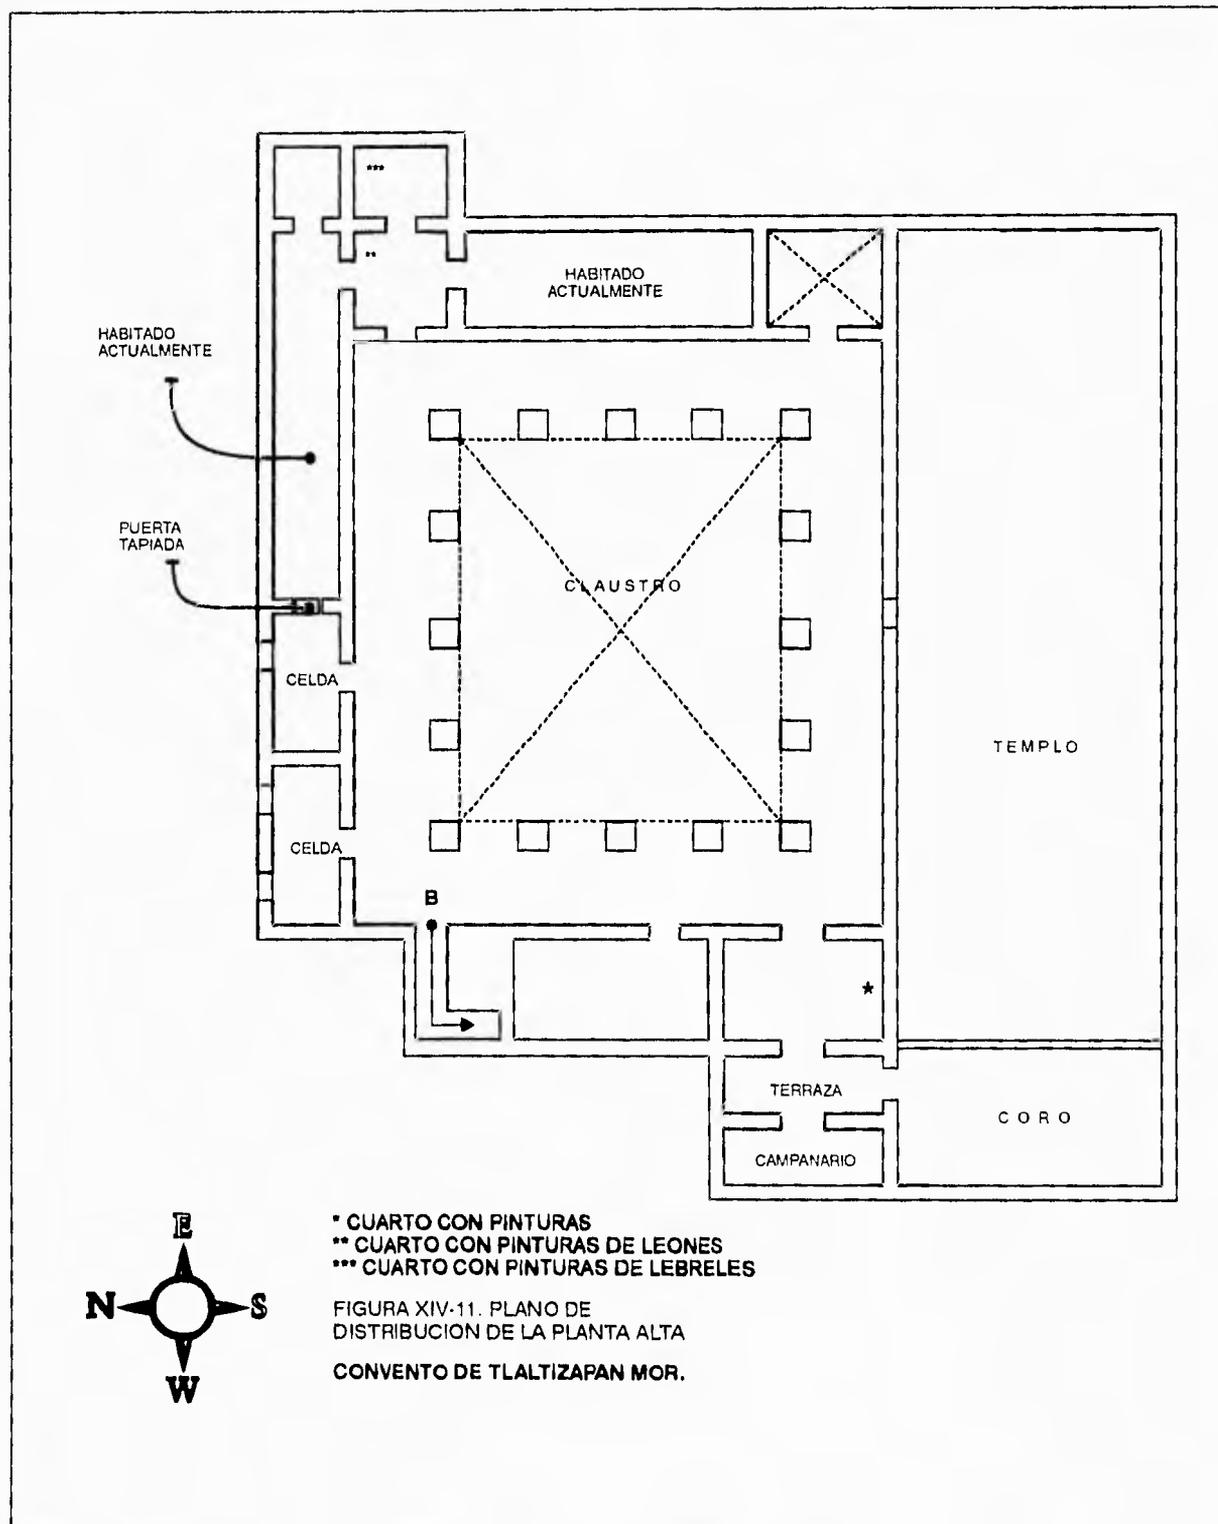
Plano de distribución de la planta alta del convento de Tlaltizapán.
